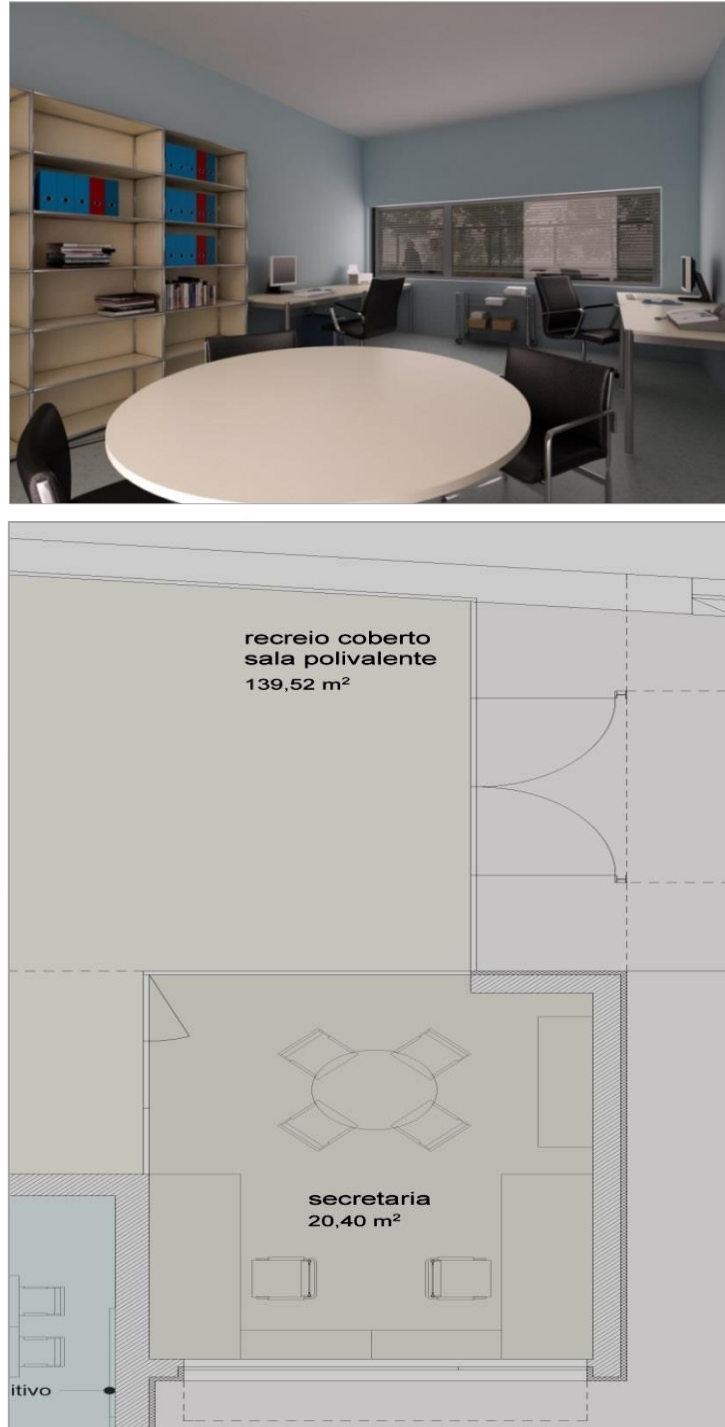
Imagem em 3D e planta da secretaria, da nossa proposta de melhora da escola.
